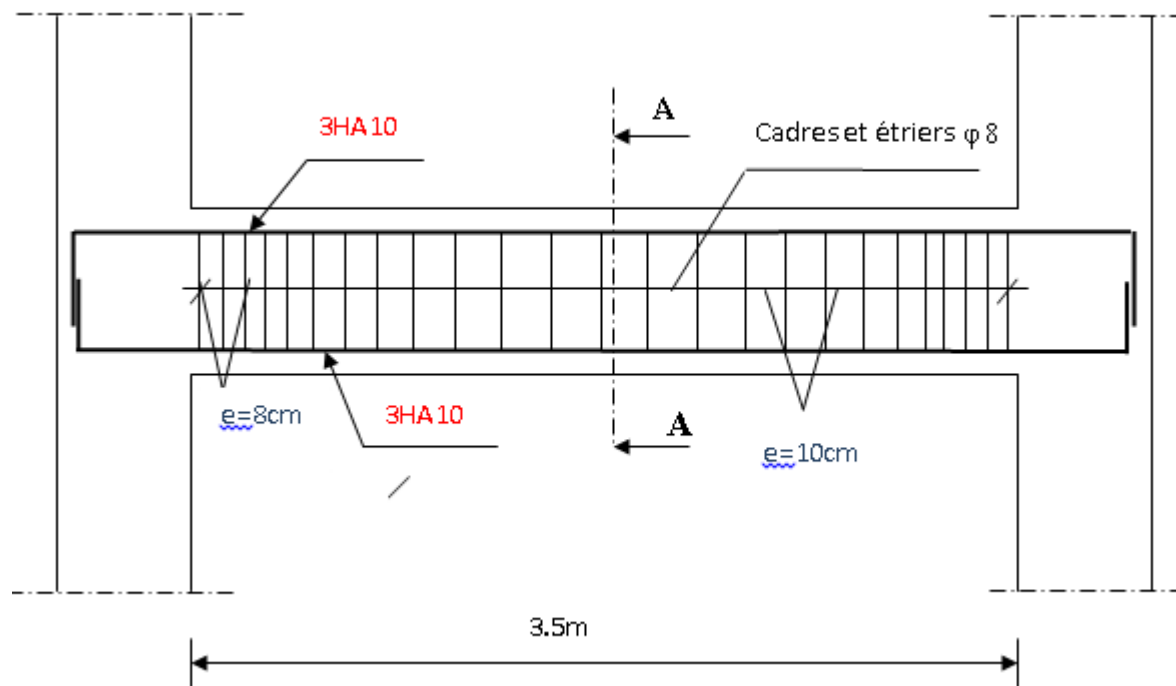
FERRAILLAGE DE LA POUTRE PALIERE
